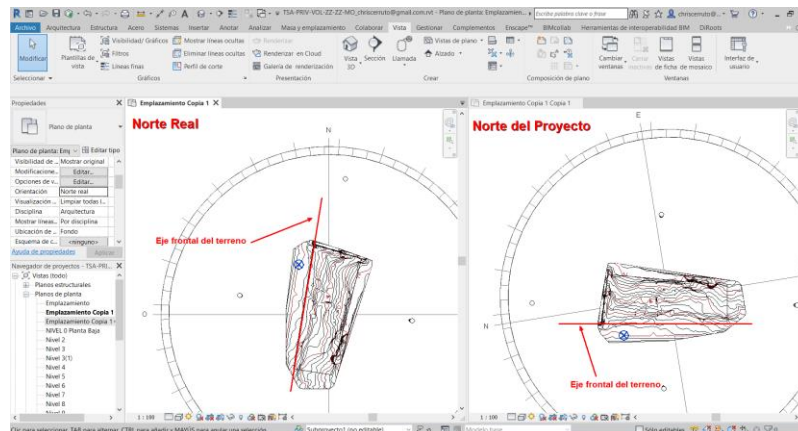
Norte Real y Norte del Proyecto - Fuente: Elaboración propia
